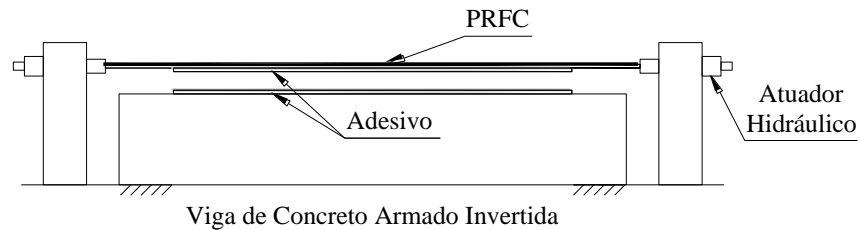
Viga de concreto armado reforçada com protensão de PRF
